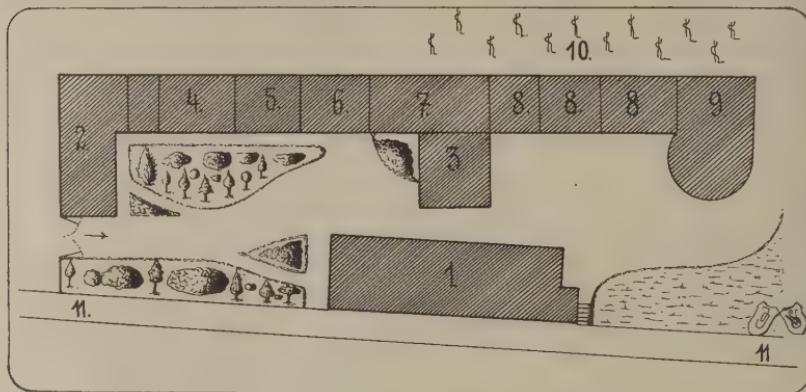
Grundriß des Szilágysomló Herrenhauses.
